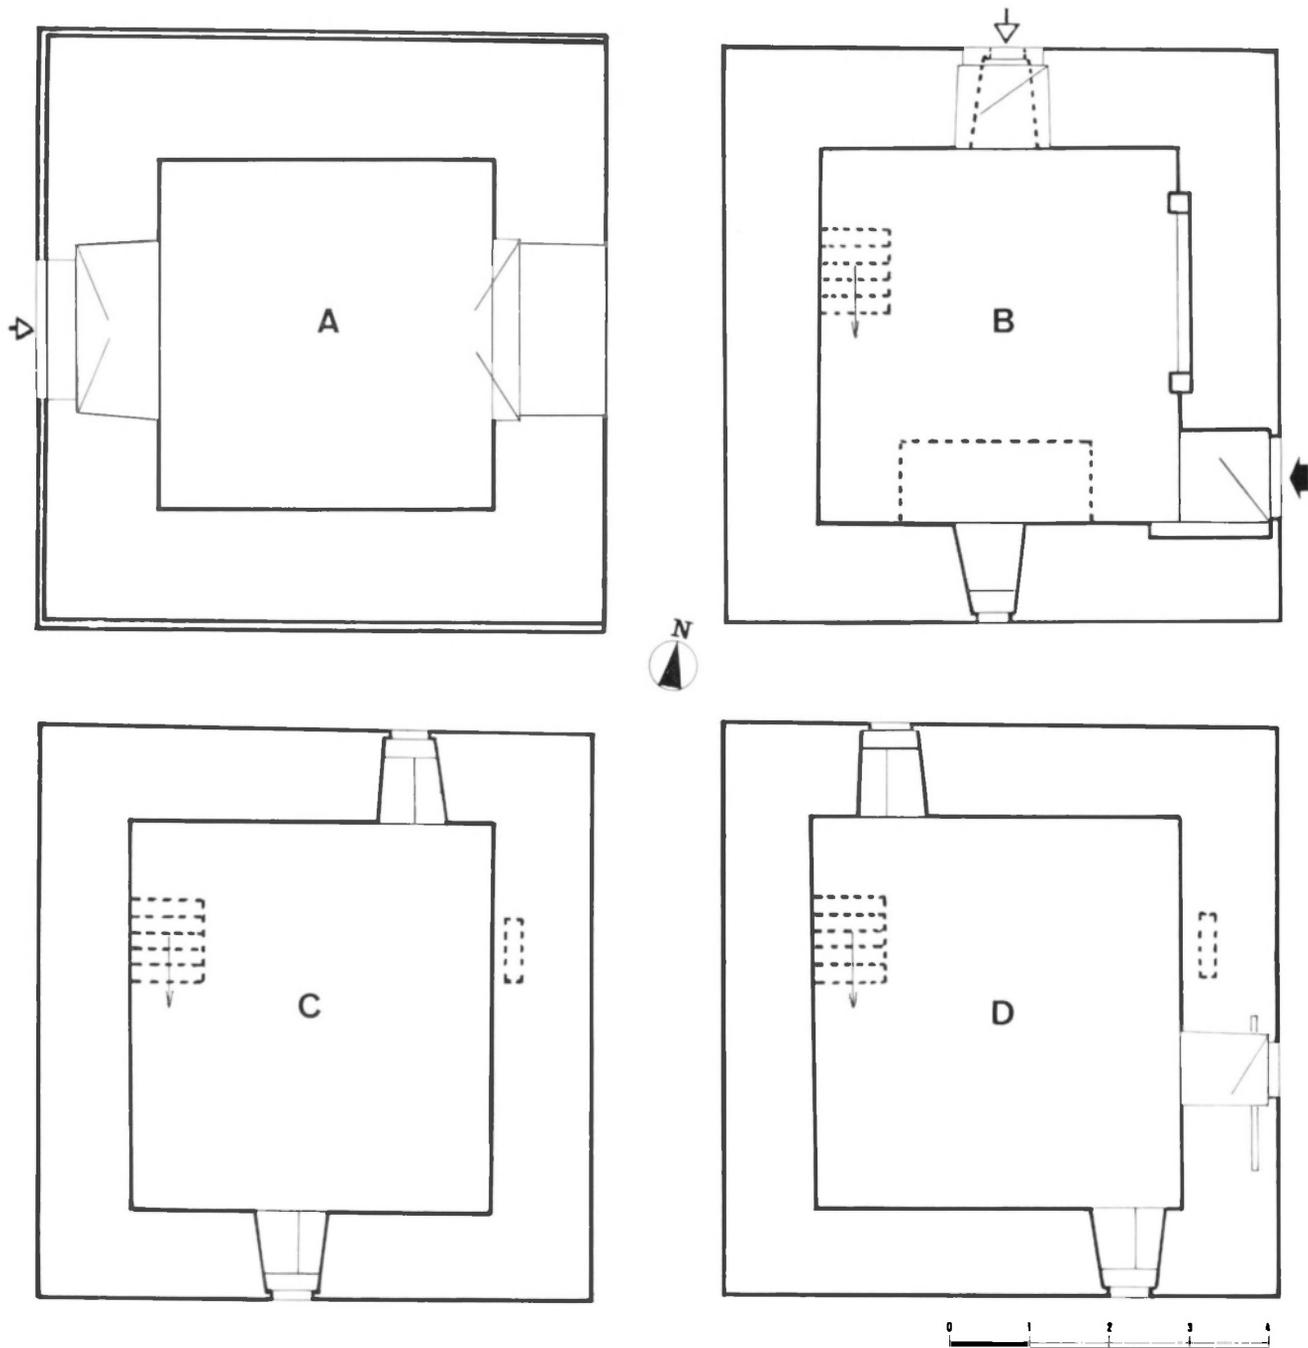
Warsage; coupes horizontales du rez-de-chaussée et des niveaux +1, +2 et +3.
